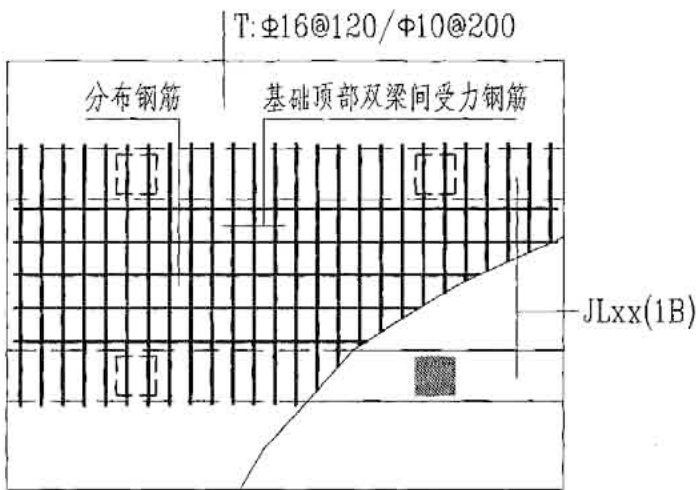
四柱独立基础底板顶部基础梁间配筋注写示意
